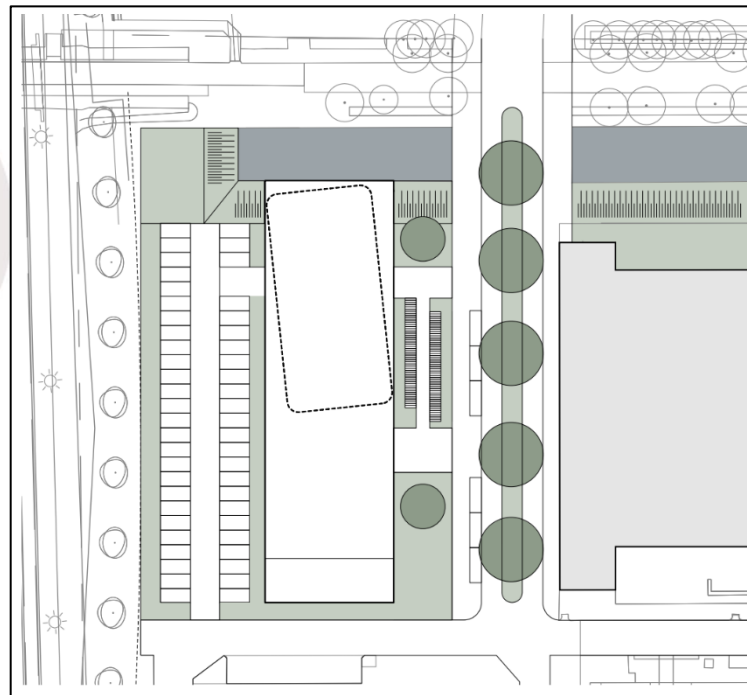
, Maaiveldinrichting van voorgenomen plan (bron: inbo)
